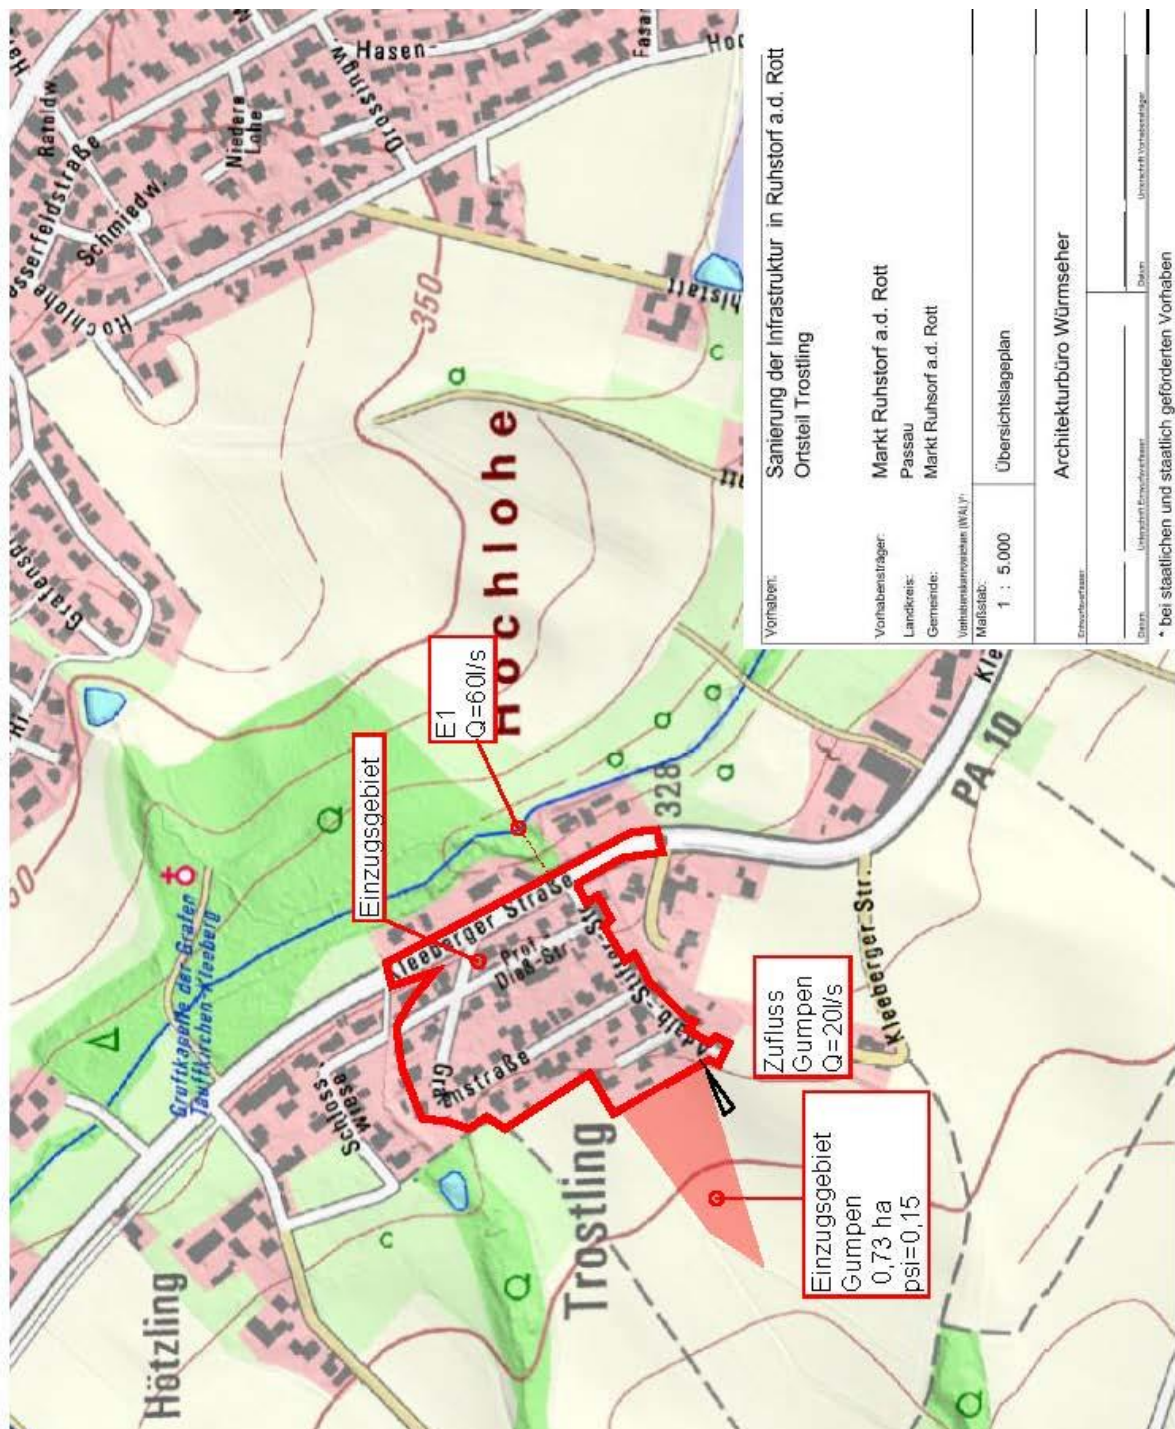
Übersichtslageplan Einzugsgebiet mit Trennung der Leitungen Quelle: (Architekturbüro Würmseher 2024)
